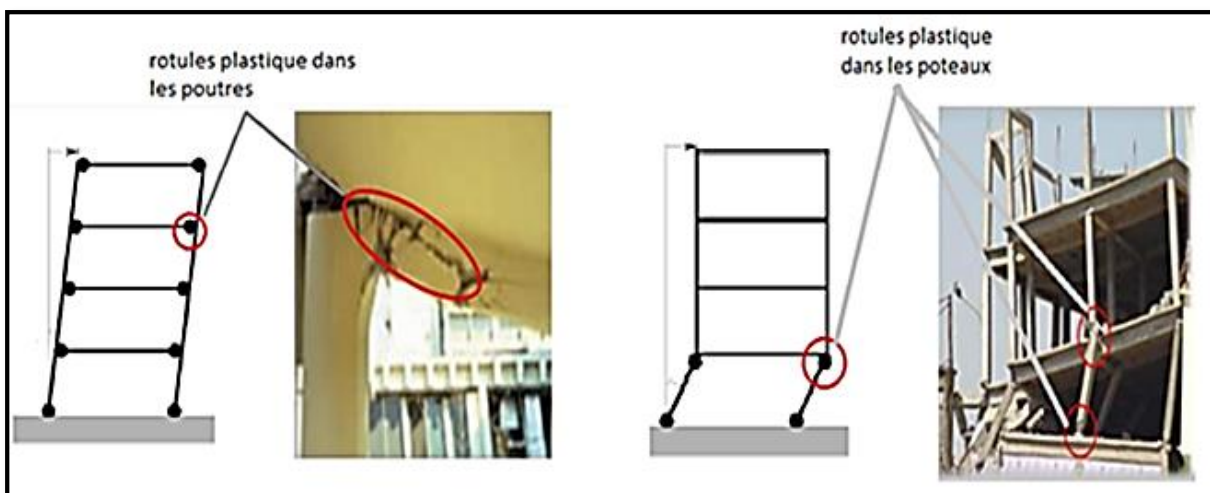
Rotules plastiques au niveau des poteaux et des poutres
